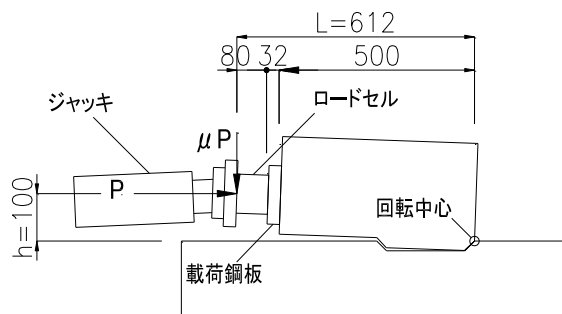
ひび割れ後の作用力（単位:mm）
